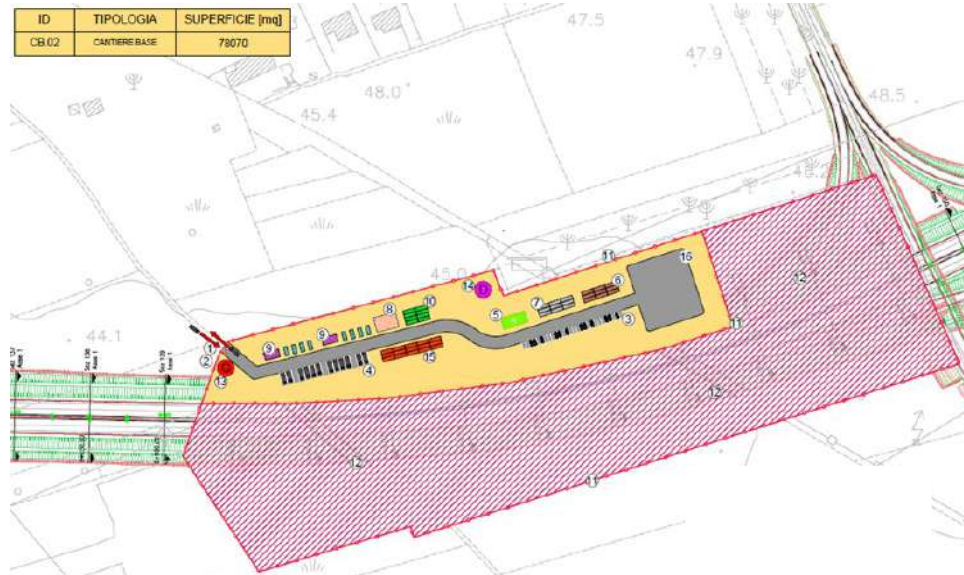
STRALCIO PLANIMETRICO DEL CANTIERE BASE 1
